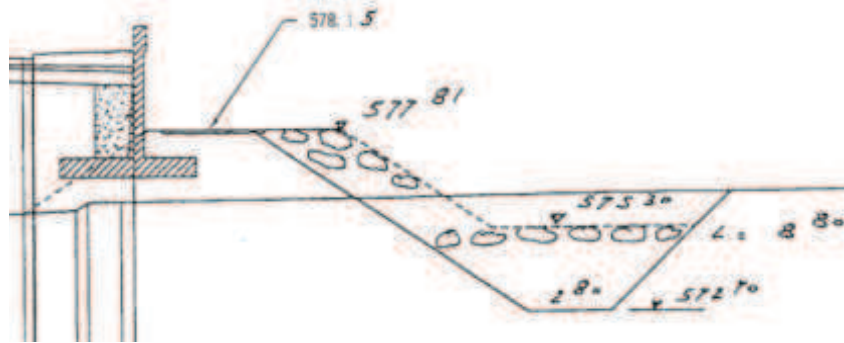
Plan de recollement de la protection de berge en amont du ravin de St-Véran.
